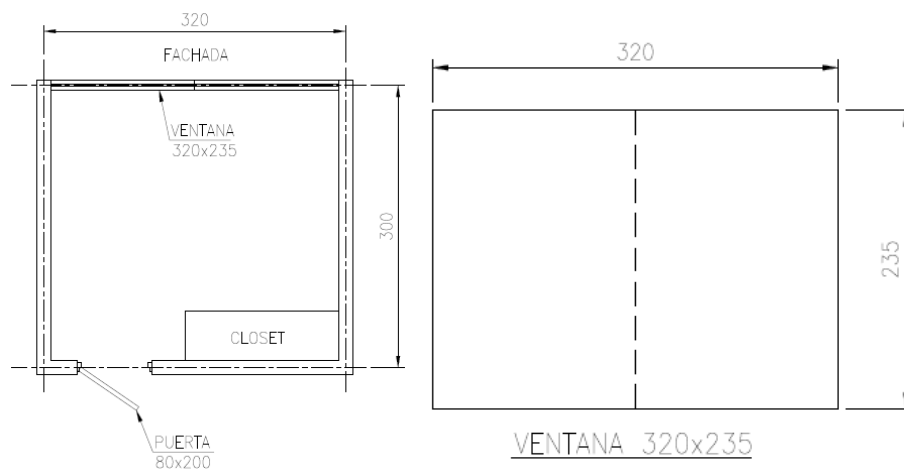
Vista en planta y elevación del recinto utilizado para el ensayo.
